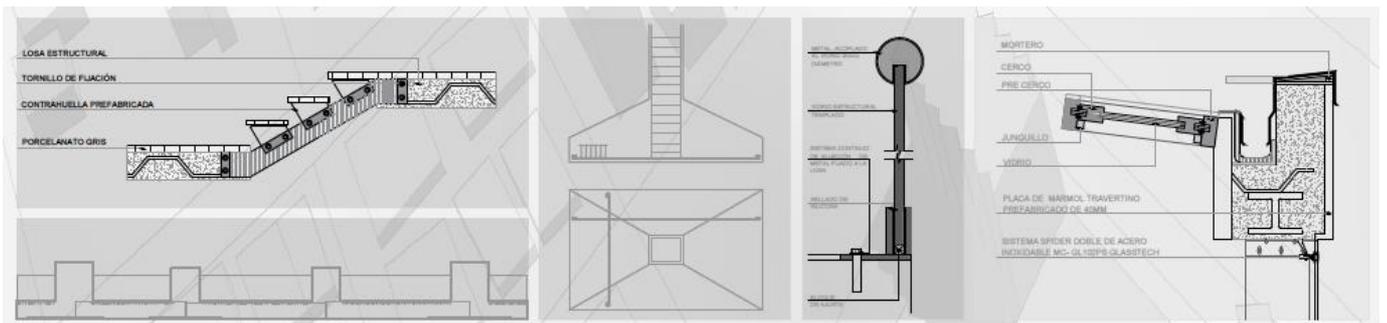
Detalle escaleras, losa cimentación, zapata, pasamanos, parapeto. Elaboración propia
